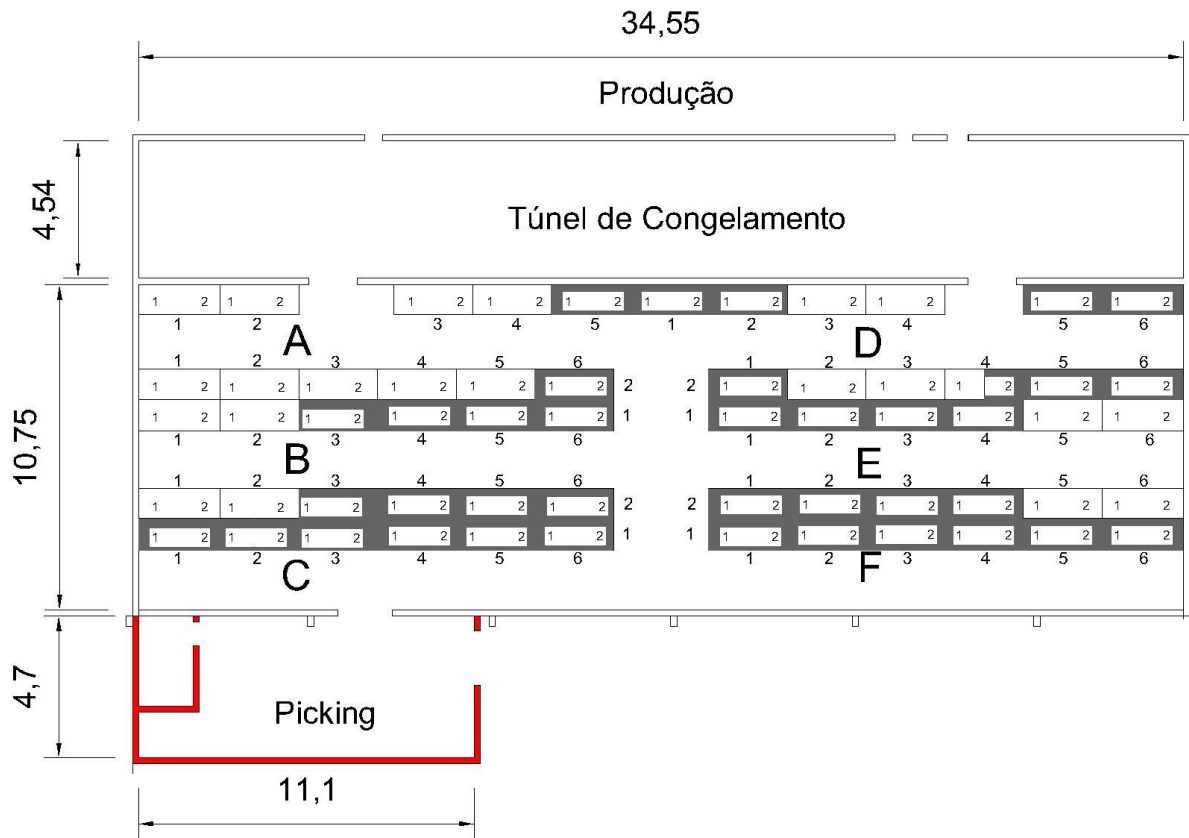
Layout/Planta Baixa Proposta da Câmara Fria com Endereçamento
